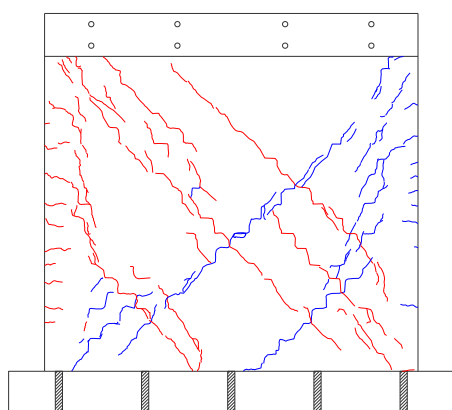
Reparación tipo II en muro de albañilería confinada con ladrillos sólido artesanal en la distorsión 1/550.
